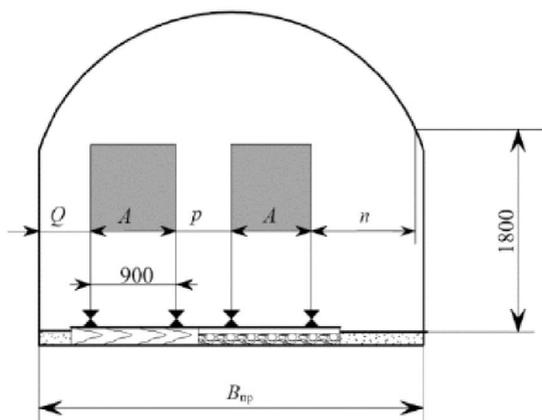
Схема к определению поперечного сечения горной выработки
